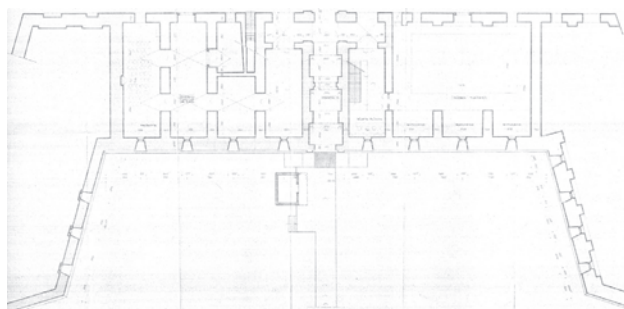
Plan du rez-de-chaussée du musée prévu sur Șimian. Archives de l'INP.
